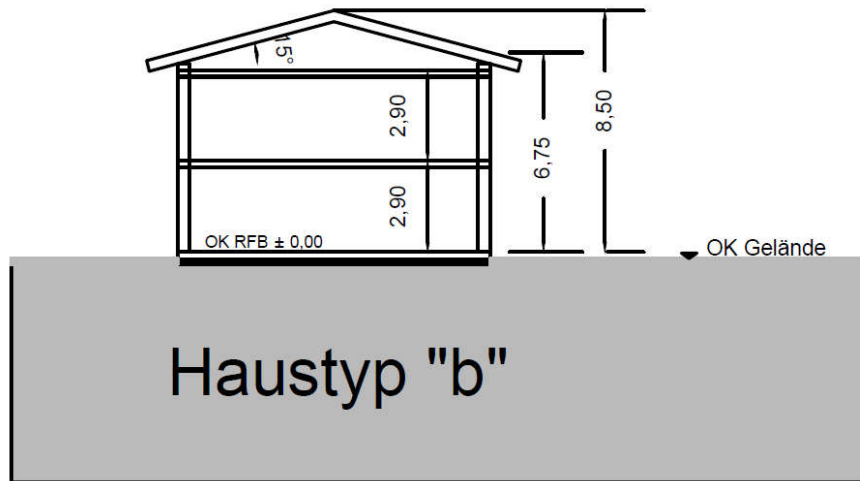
Systemschnitt Haustyp „b“ zwei Vollgeschosse
